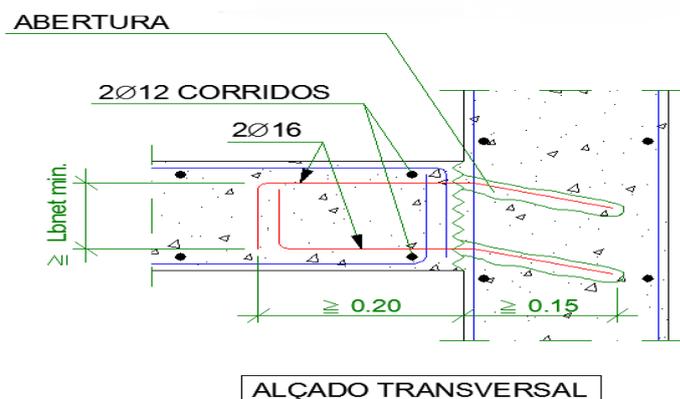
Pormenor de ligação de estrutura existente com estrutura nova
